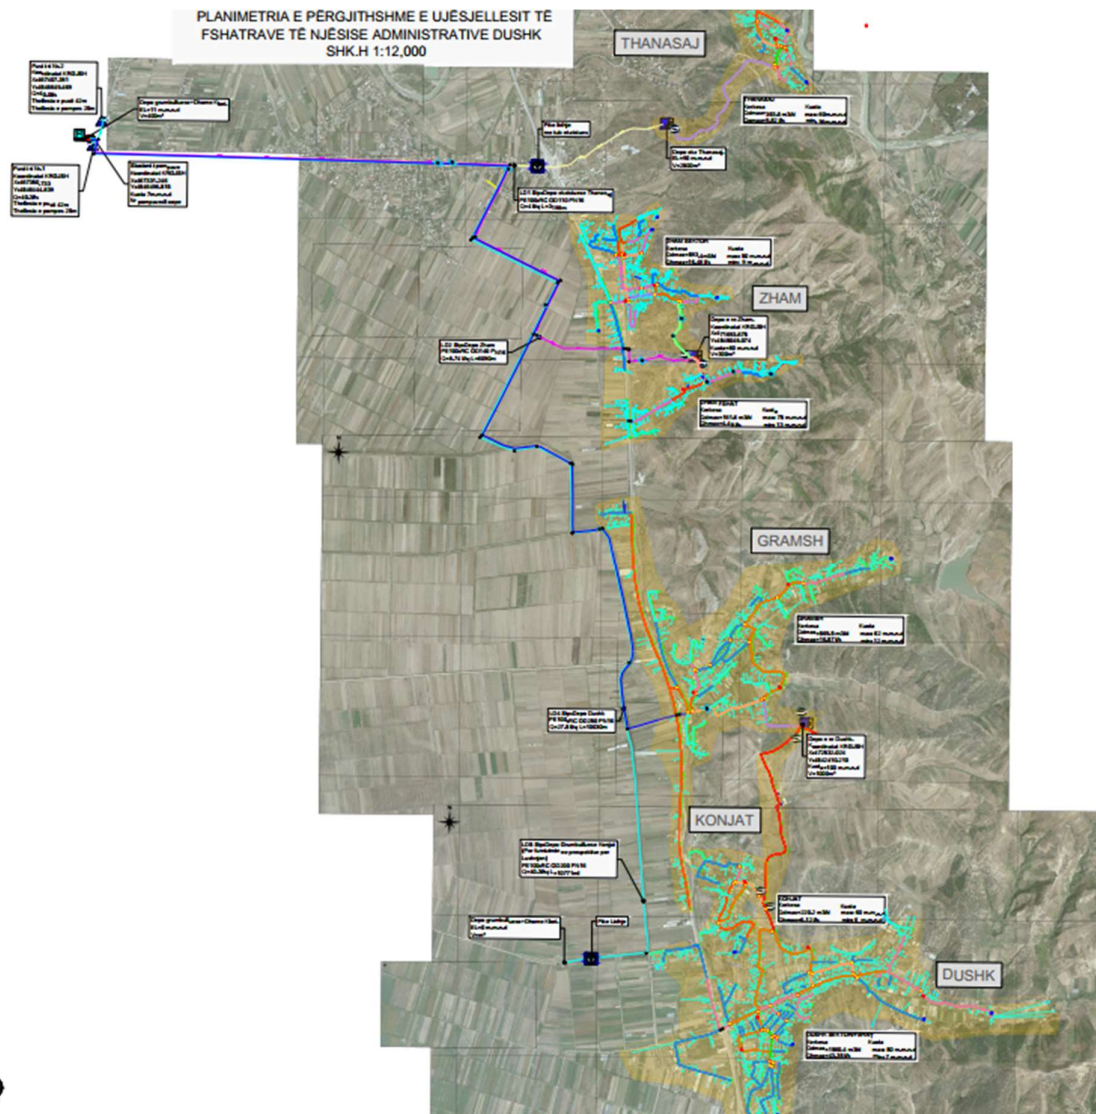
Planimetria e Pergjithshme e Ujesjellesit te Fshatrave te Njesise Adm. Dushk.
